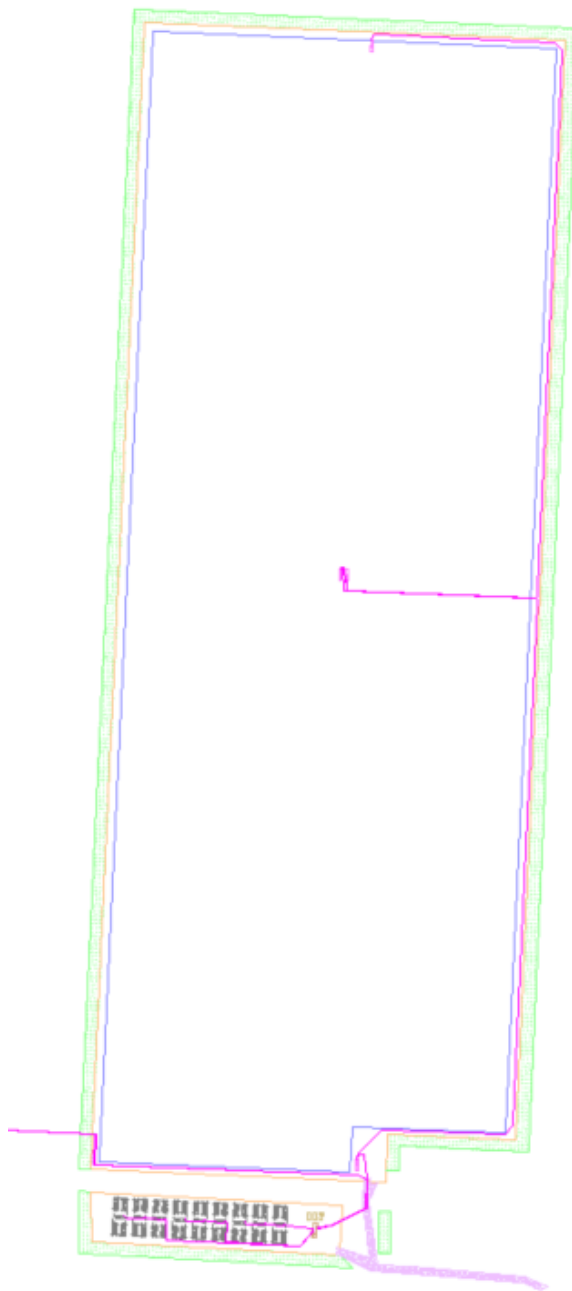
Planimetria cavidotti su layout - sottocampo est.
